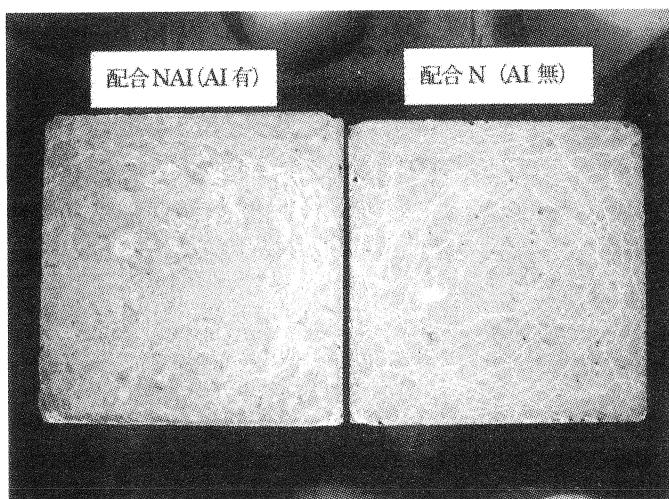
硬化コンクリート時の打設面のひび割れ性状（材令91日）
